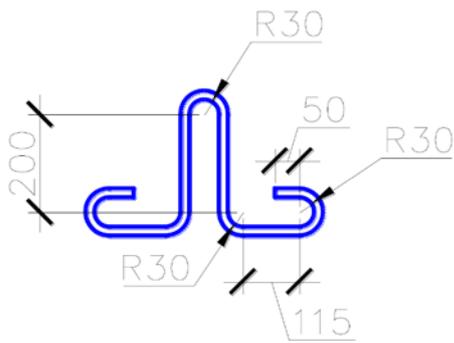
Узел детализировки закладной детали (проушина для крепления стяжных ремней)
